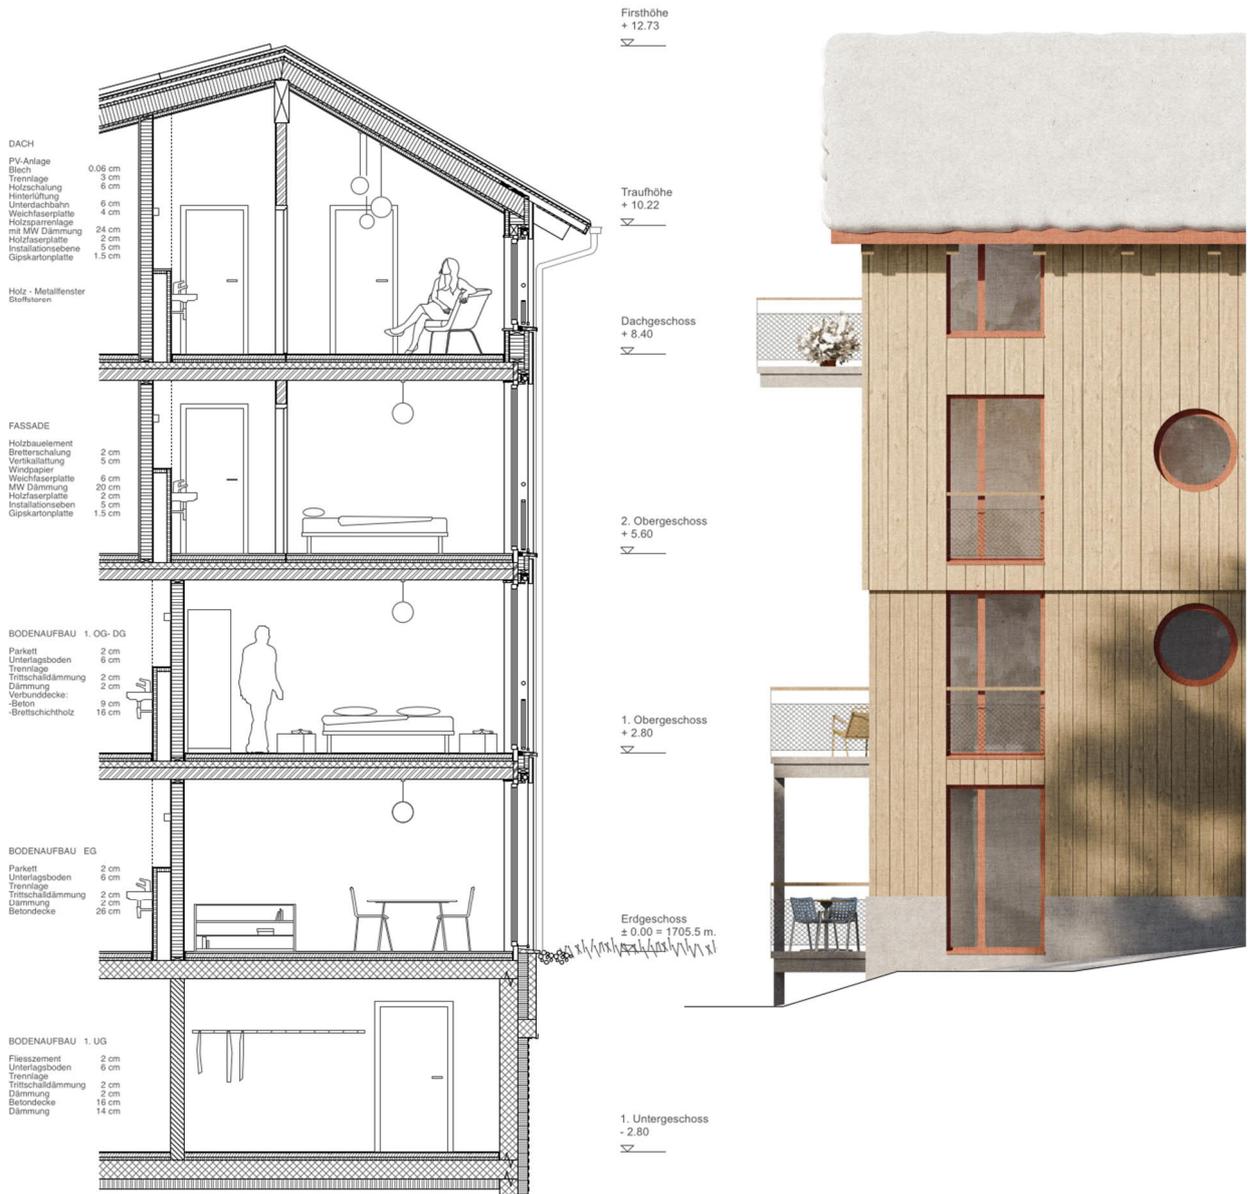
Fassadenschnitt DREI RÖSLI (massstabslos)
